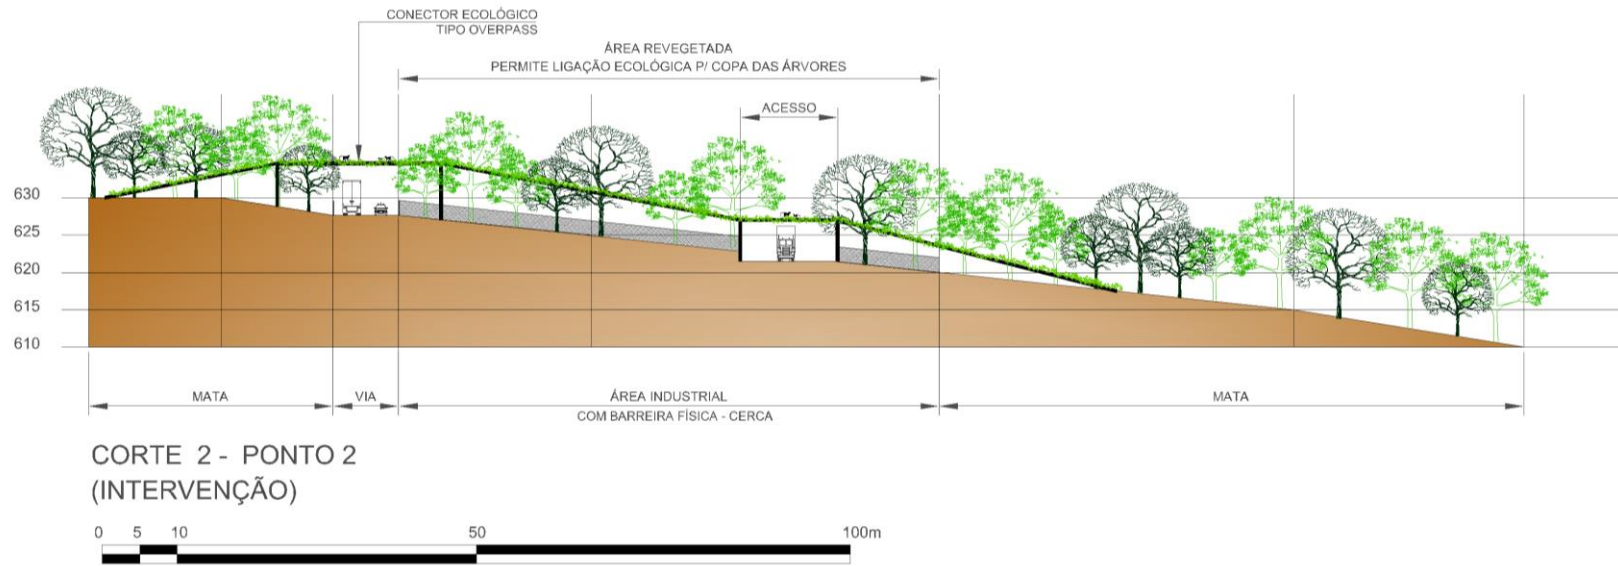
Corte Transversal 2.2, intervenção no Cenário 2. Autoria Pessoal
